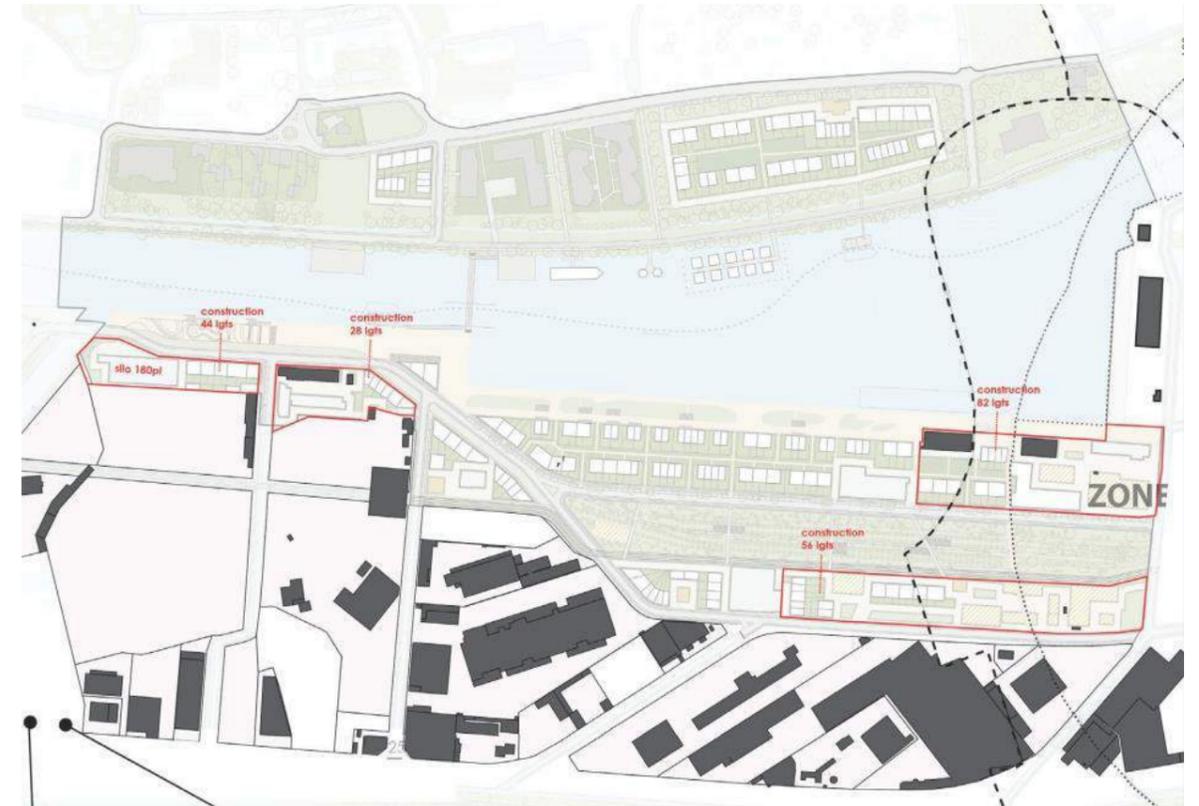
Phase 4 autour du Canal – Site Nouveau Bassin à Caen (source : Plan Guide MVRDV)
